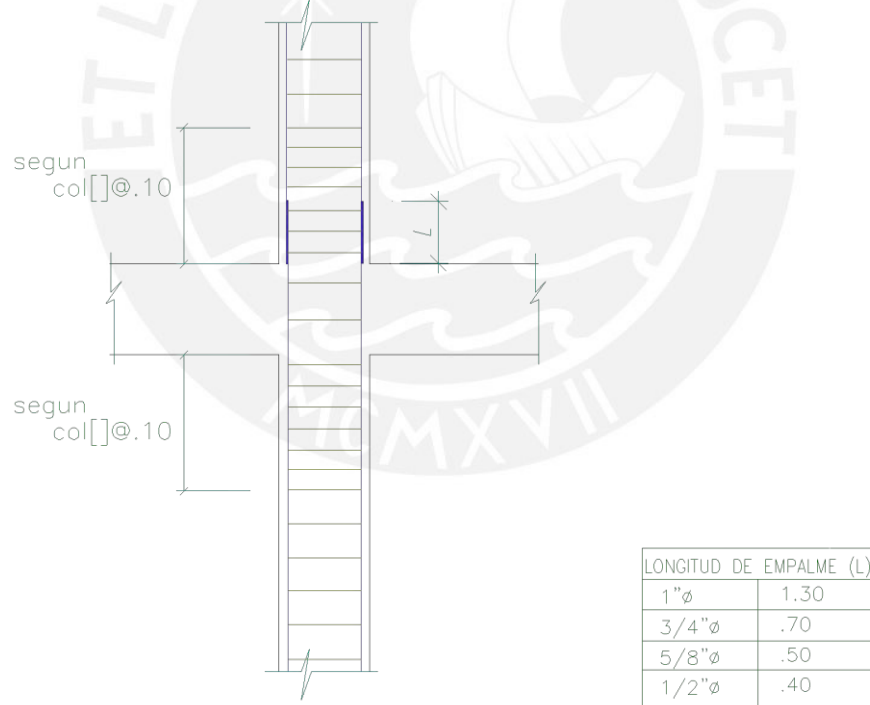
EMPALMES EN COLUMNAS EN ZONAS DE REFUERZOS ALTOS.
